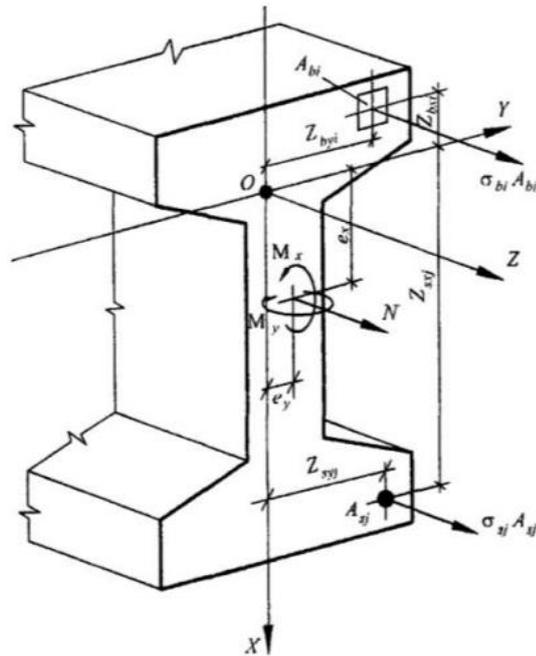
Расчетная схема нормального сечения железобетонного элемента (общий случай)
